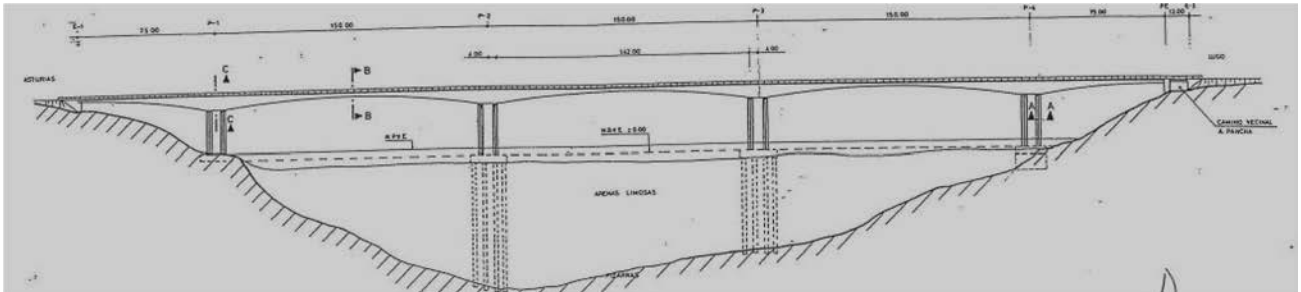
Alzado del puente de Los Santos previo a su ampliación.
